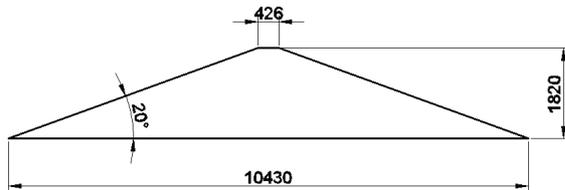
Геометрическая схема кровли / Geometric roof scheme
